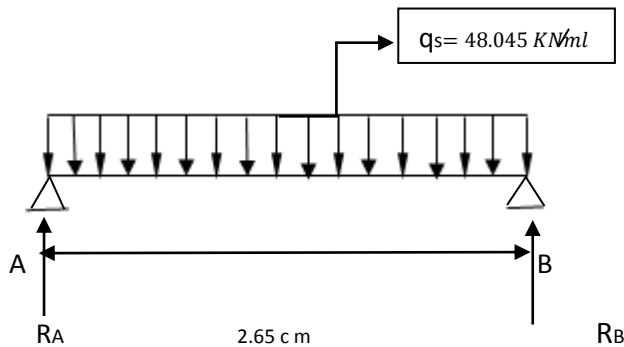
Schéma statique de la poutre palière (ELS)
